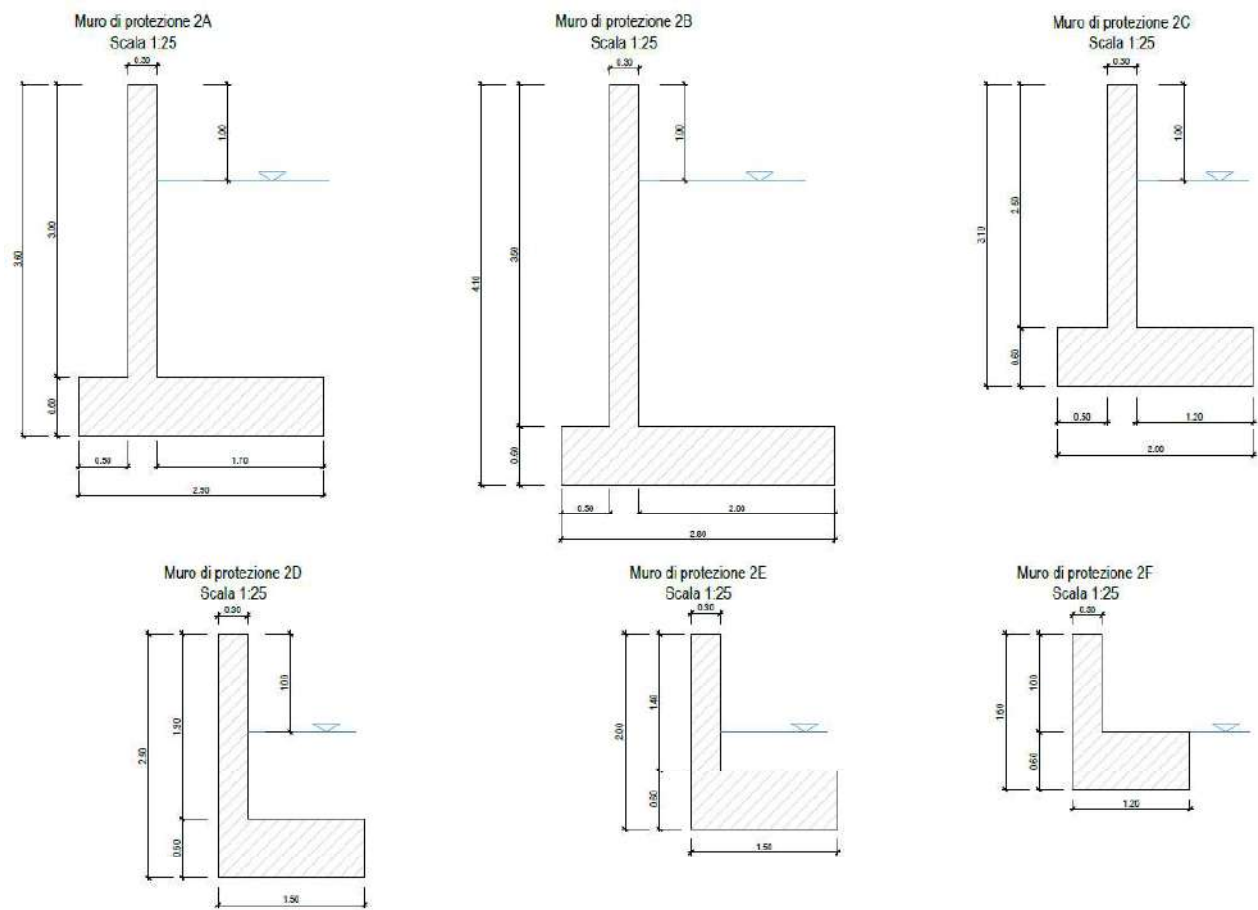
Sezione tipo dei muri di protezione – Muro 2
